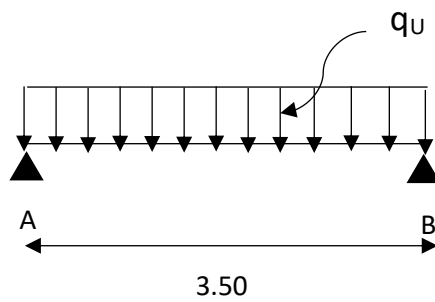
Schéma statique de la poutre continue reposant sur deux appuis.
